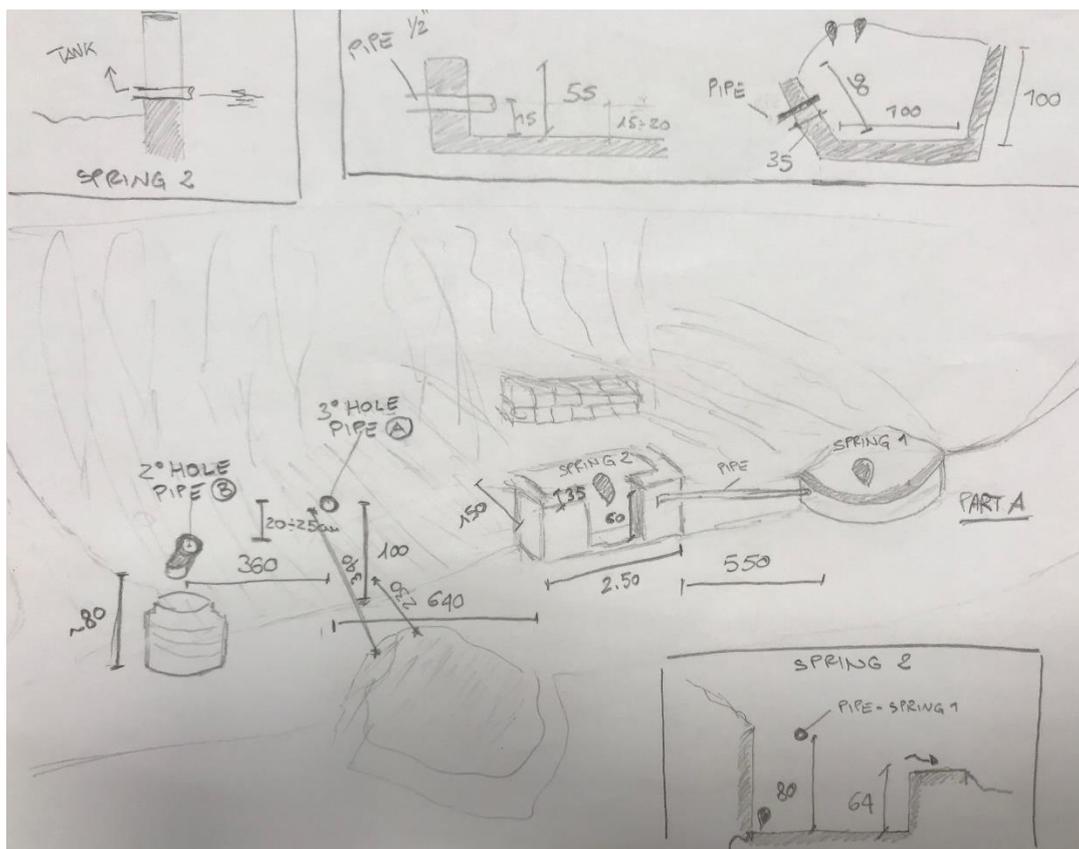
fogli di cantiere con rilievo delle aree oggetto delle lavorazioni
